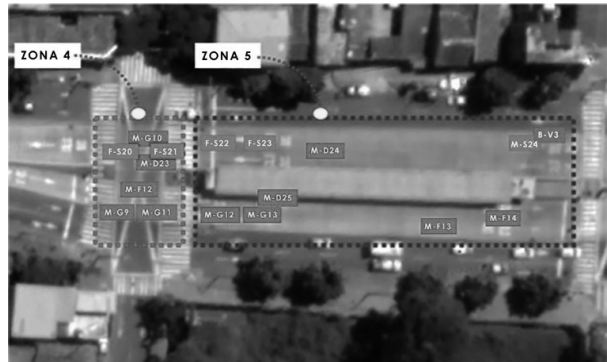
Levantamiento planimétrico de daños Zona 4 y Zona 5.
